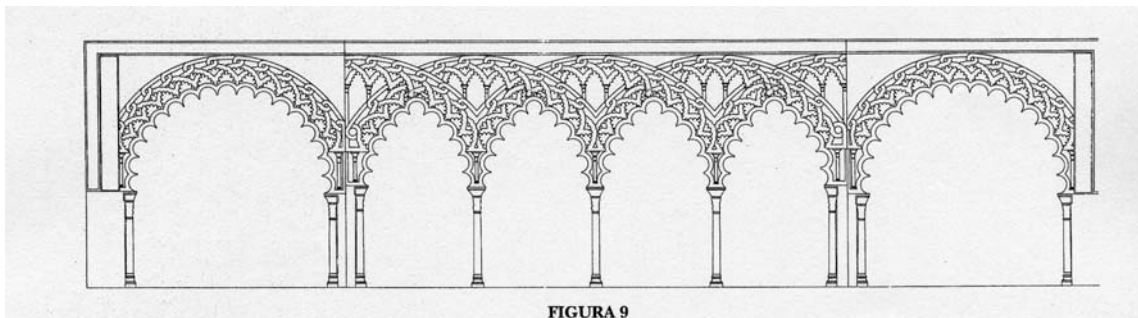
Reconstrucción del Pórtico Norte según Ewert (1978: vol. III, lám. 31)
